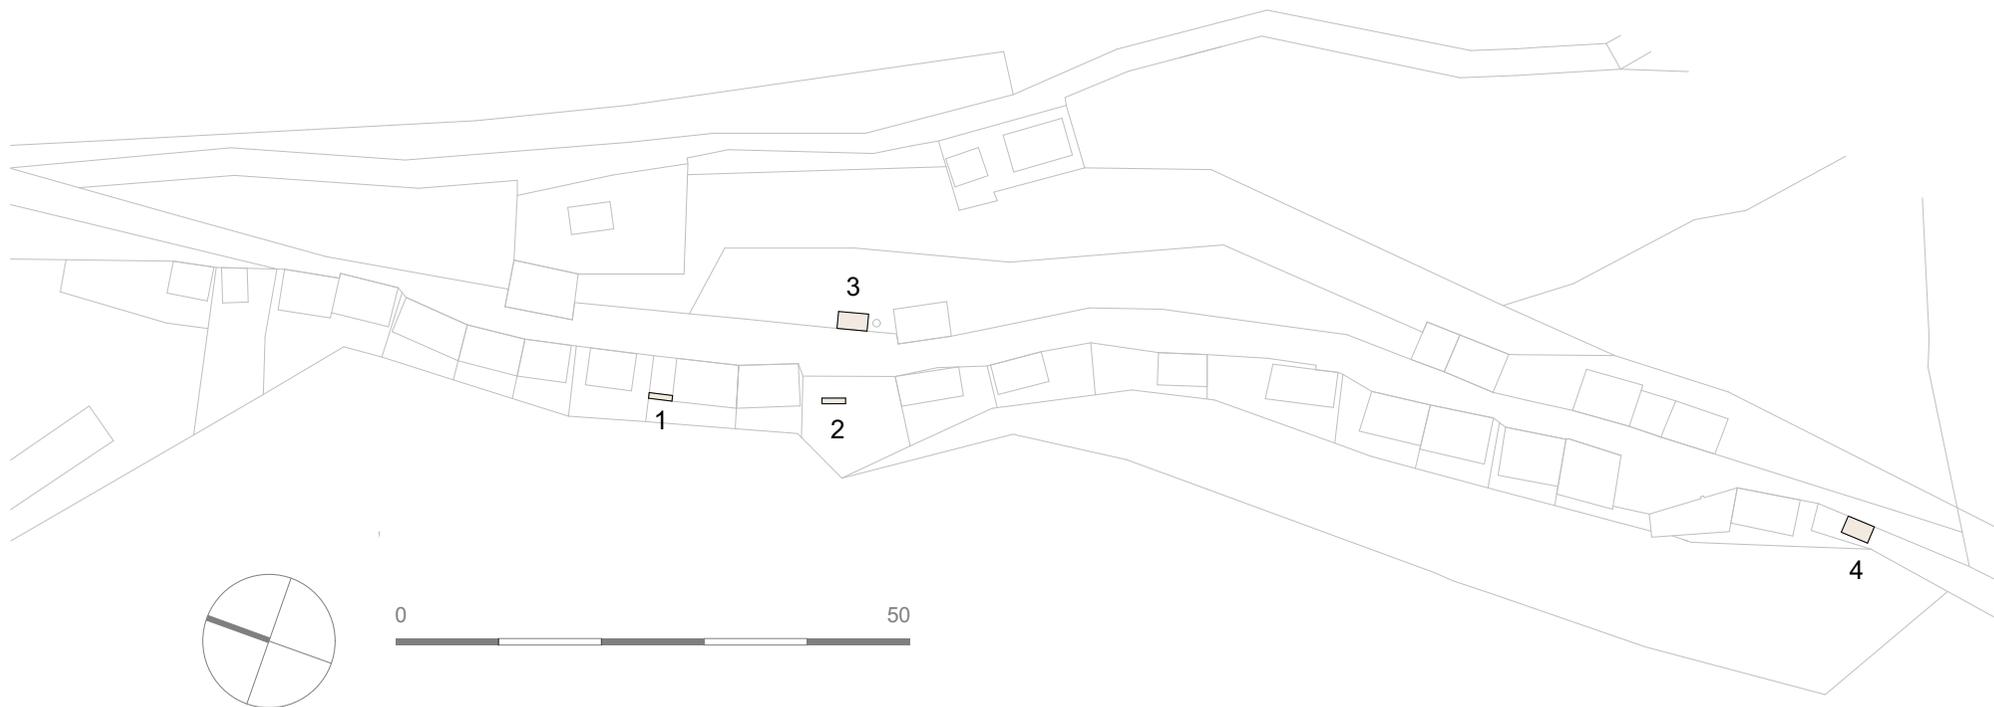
Lageplan Vorkappl Maßstab 1:1000
